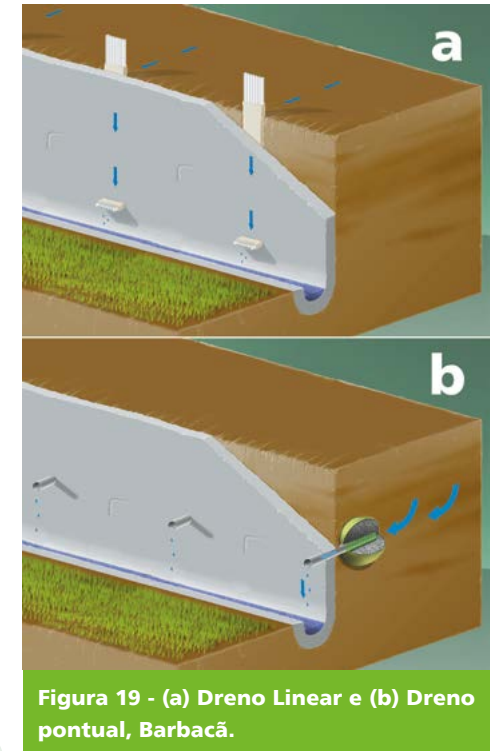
(a) Dreno Linear e (b) Dreno pontual, Barbacã.
